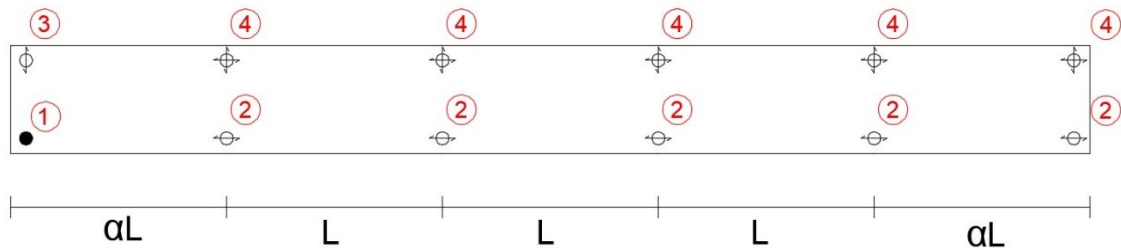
Disposizione planimetrica dei dispositivi di appoggio.
